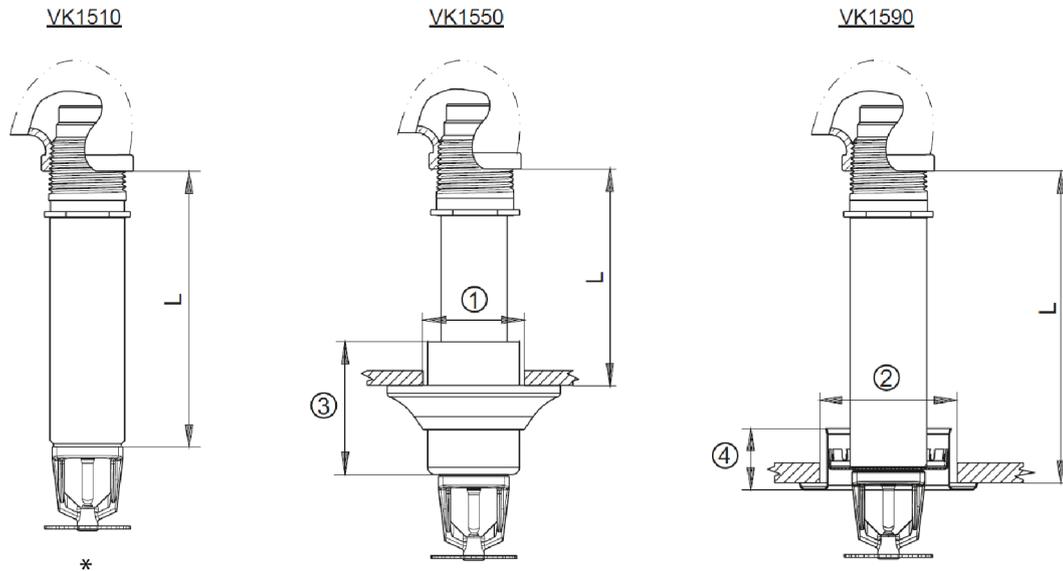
Bestimmen des Einbaumaßes "L", alle Sprinklervarianten
